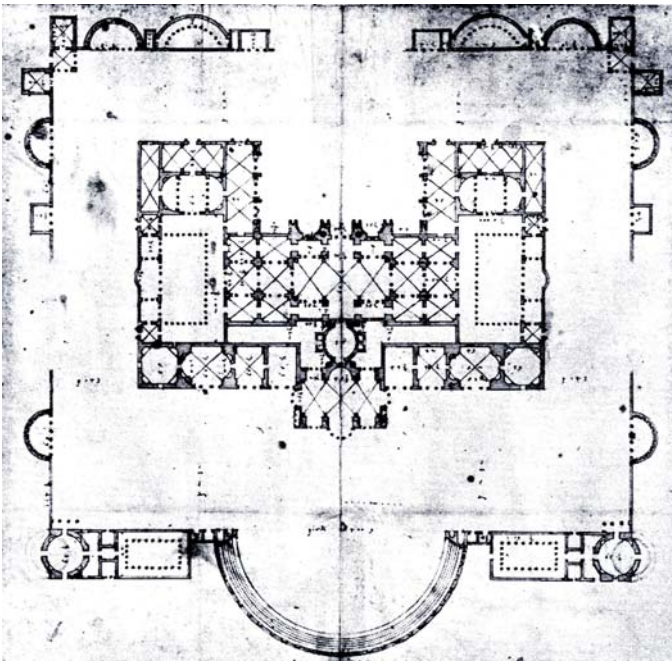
e 8: Planta (RIBA VI/1) e cortes/fachadas (RIBA VI/4), segundo Palladio.
